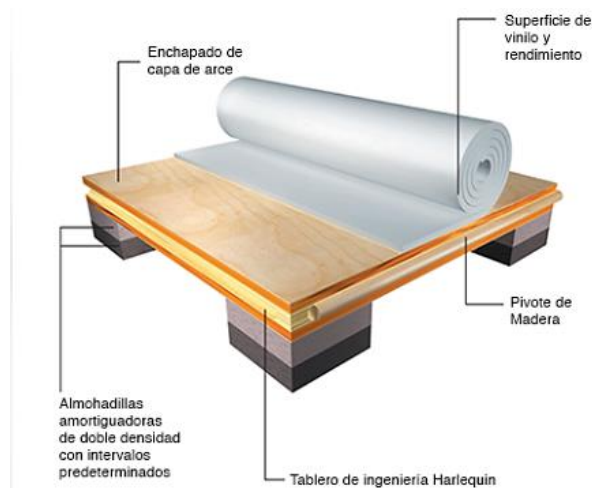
Detalle constructivo Piso Harlequin Liberty.
